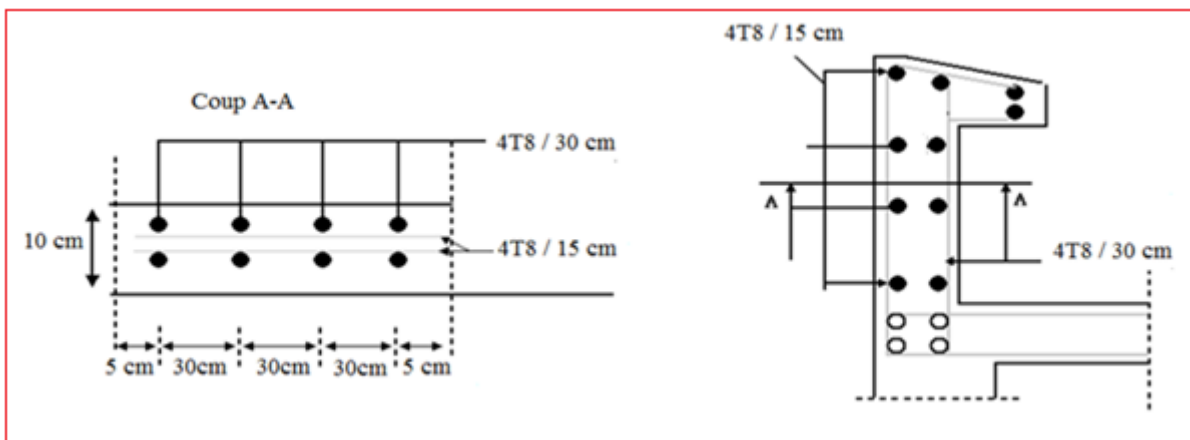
Coupe longitudinale du ferrailage de l'acrotère.
